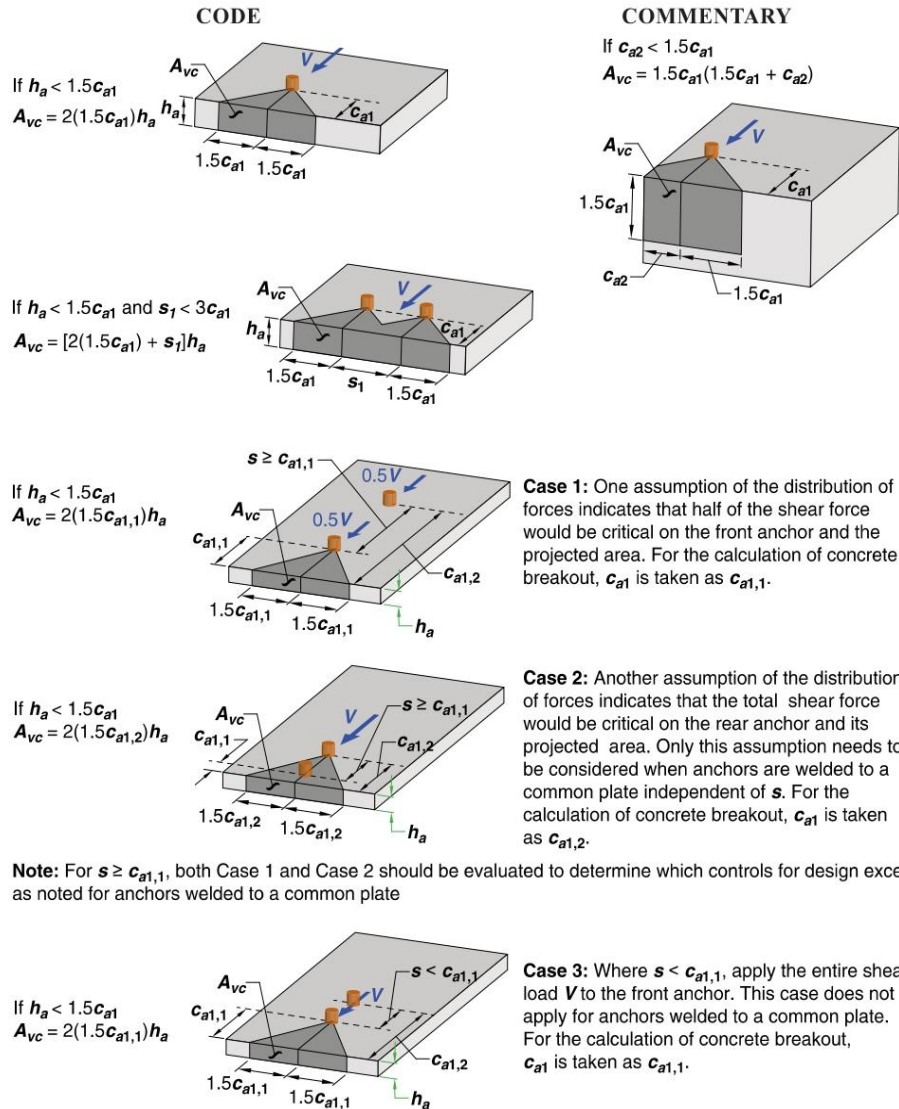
Cálculo de A_{vc} para anclajes individuales y grupos de anclajes. Tomado de *Building Code Requirements for Structural Concrete (ACI 318-19)*, por American Concrete Institute, 2019. Copyright 2019 por American Concrete Institute.
